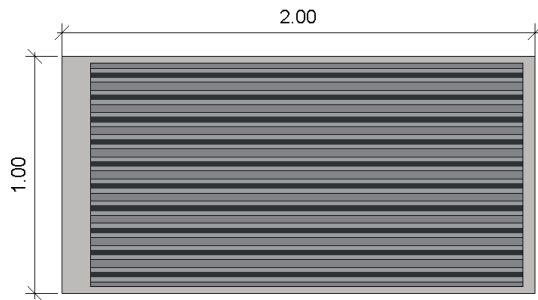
VISTA EN PLANTA DE PANEL DE CAPTACIÓN SOLAR PROPUESTO.
